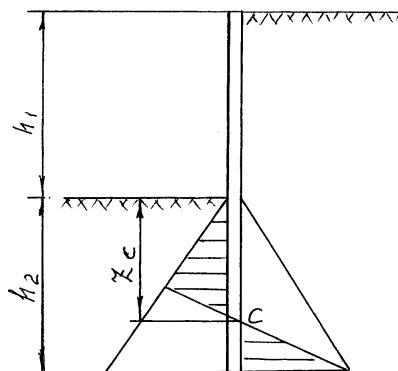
Расчетная схема тонкой незаанкеренной подпорной стены
